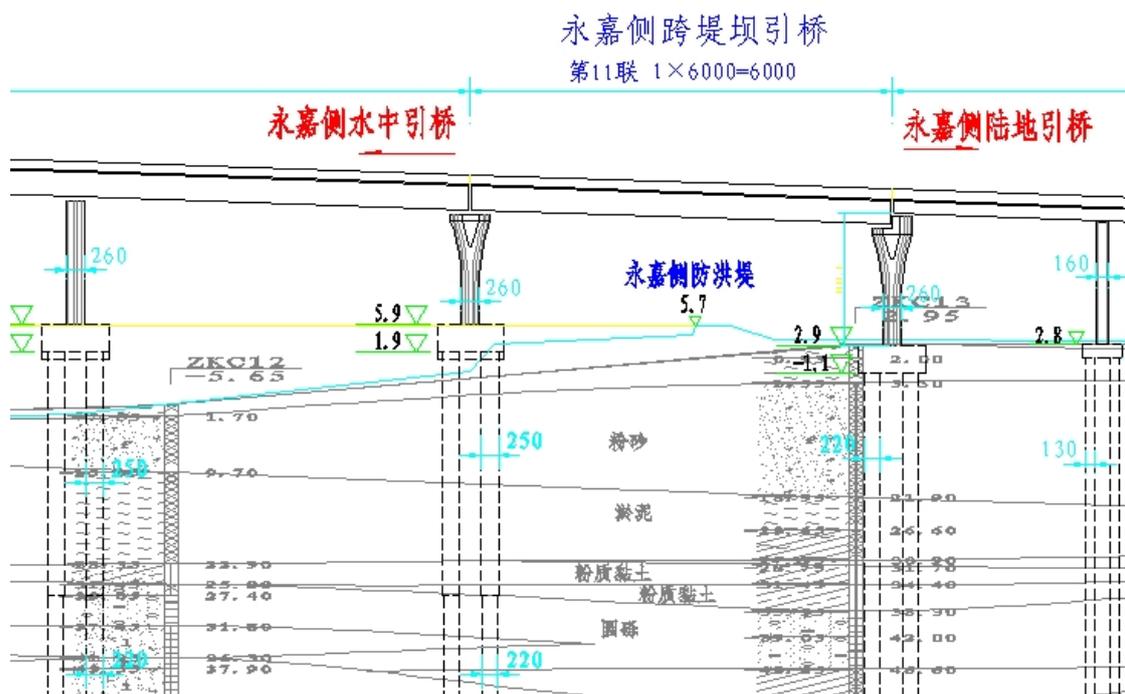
永嘉侧跨堤坝引桥桥跨布置立面图
